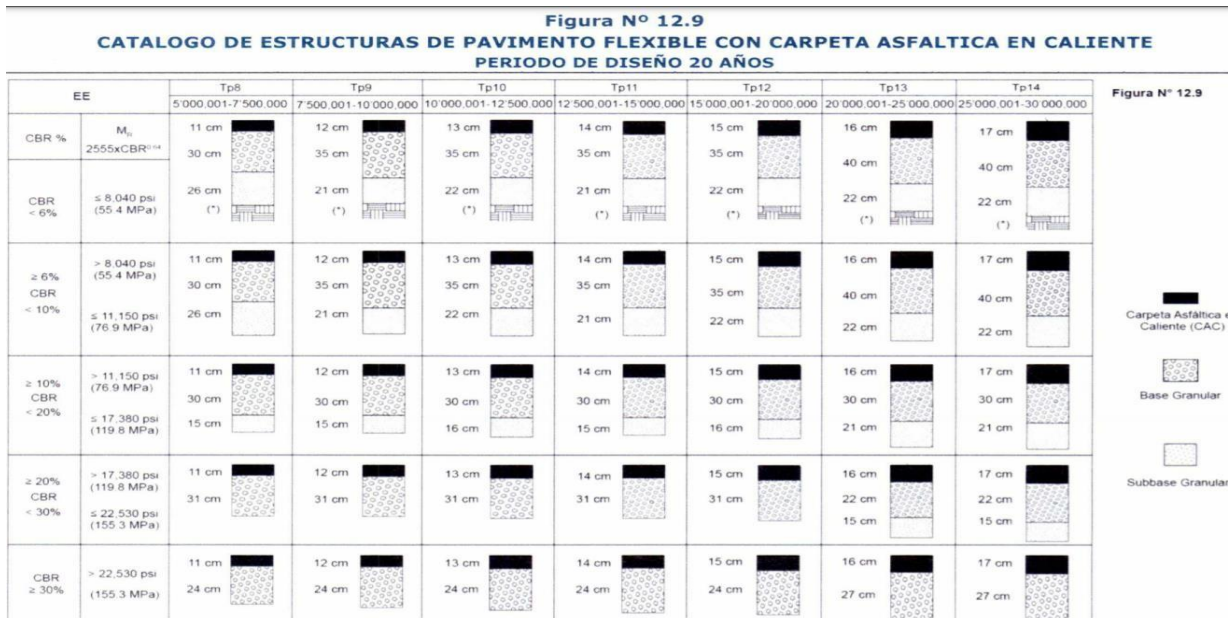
Estructuras del pavimento flexible con carpeta asfáltica en caliente, en periodo de 20 años.
